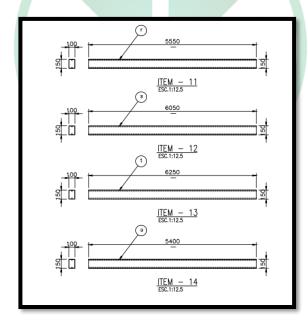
Detalhamento das vigas de travamento em perfil enrijecido
